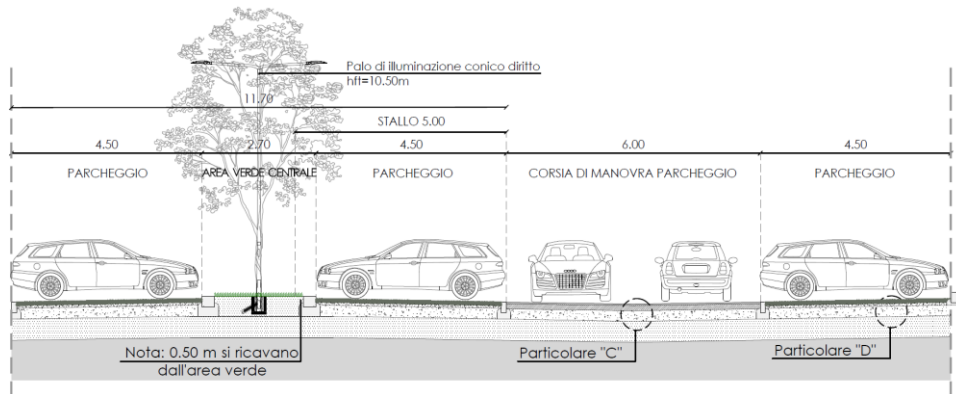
Planimetria di dettaglio e sezione tipologica parcheggio
